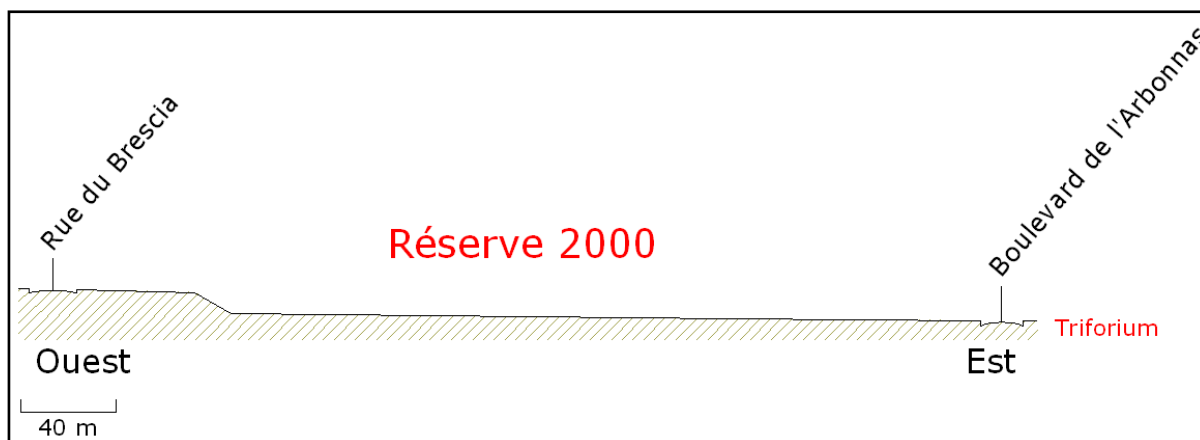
COUPE AA' DE LA RESERVE 2000 MONTRANT LA TOPOGRAPHIE DU SITE
